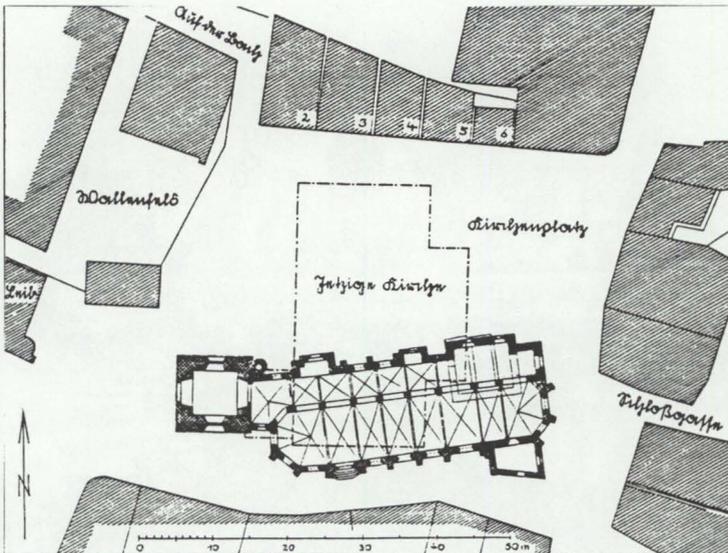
Grundriß der alten Stadtkirche, nach einer Zeichnung von 1811 im StA. Darmstadt
